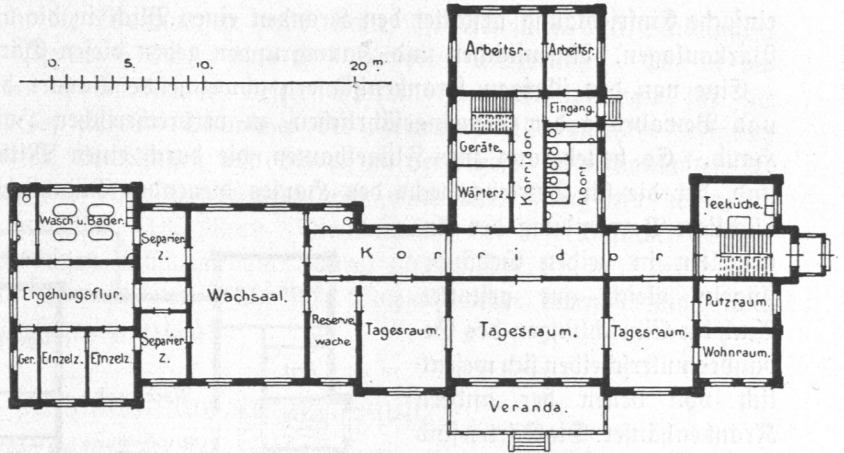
Irrenanstalt Langenhorn, Beobachtungshaus für Männer, Erdgeschoß, Grundriß.
